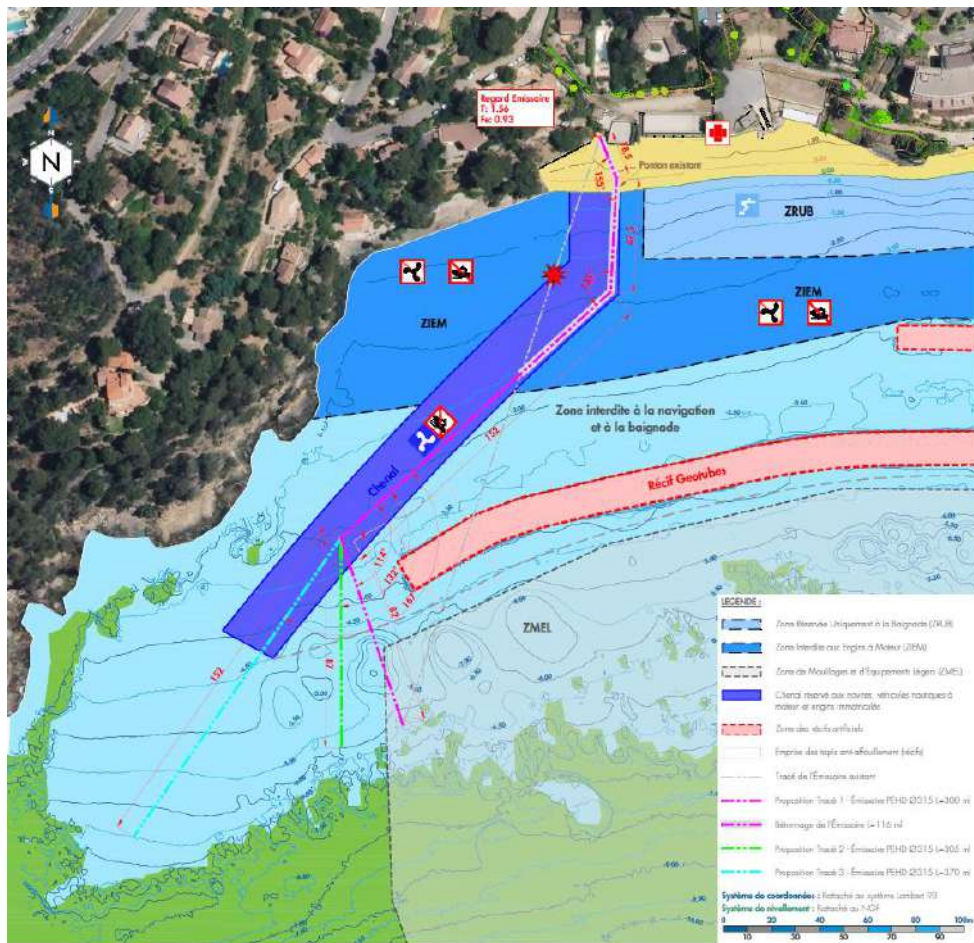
Localisation des trois propositions d'implantation (extrait du plan COR-067-21-AVP-PLAN-01-0)
